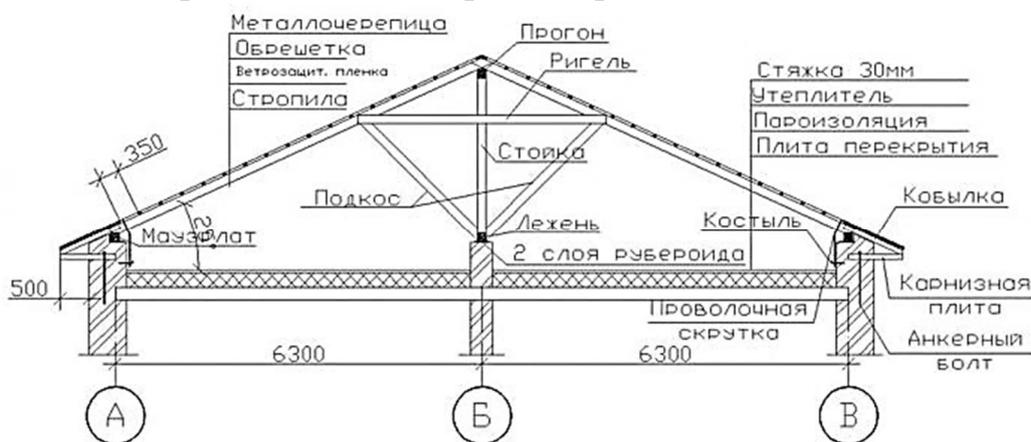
Конструкция скатной крыши по наслонным стропилами
